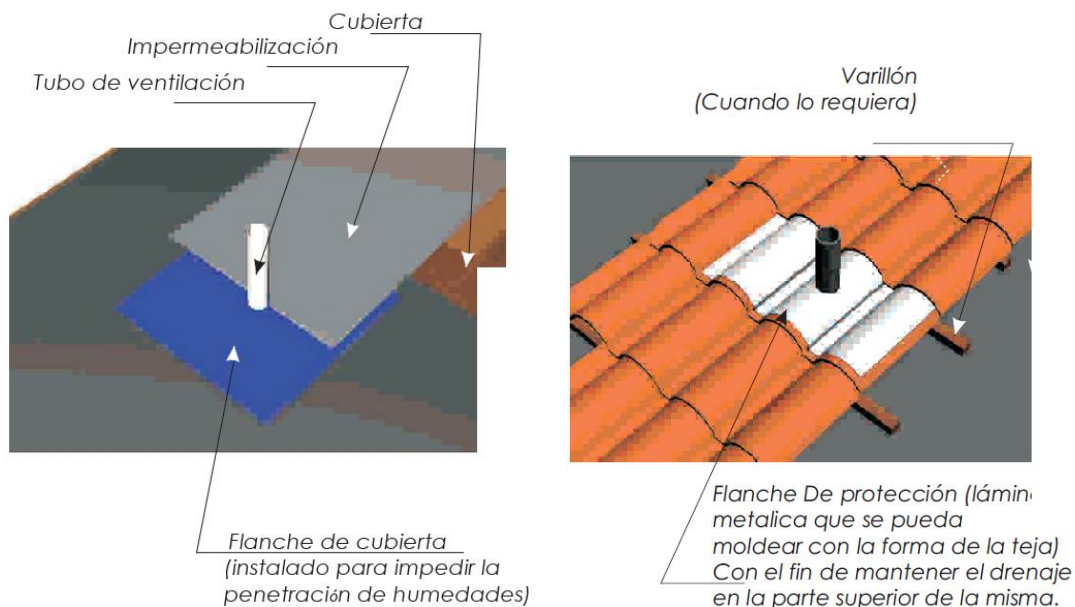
Detalle constructivo de flanches para tubos de ventilación.
